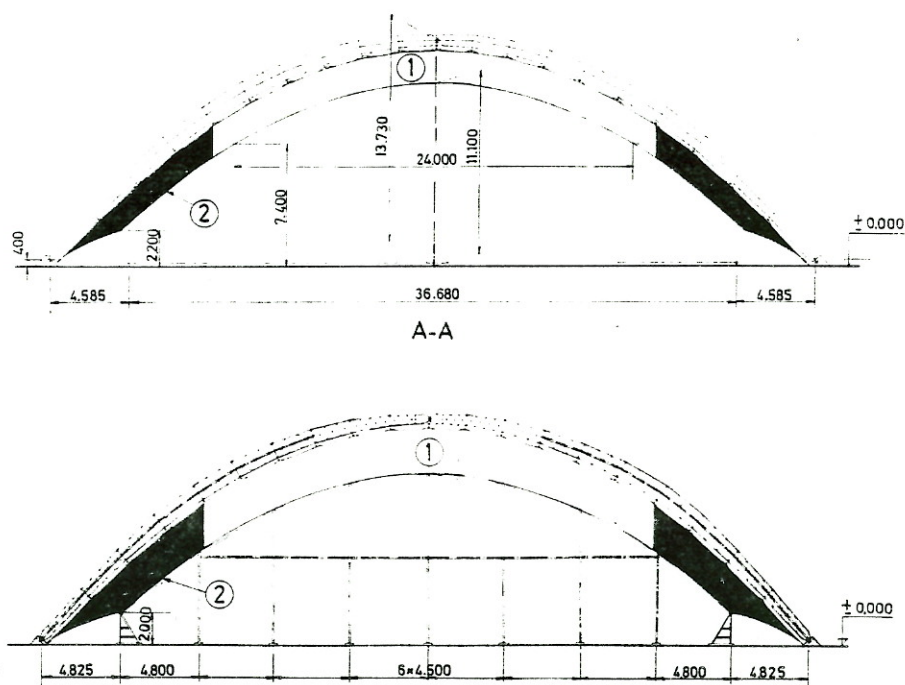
Sezione A-A della figura 3 e prospetto frontale. 1 e 2. Vedere figura 3.
